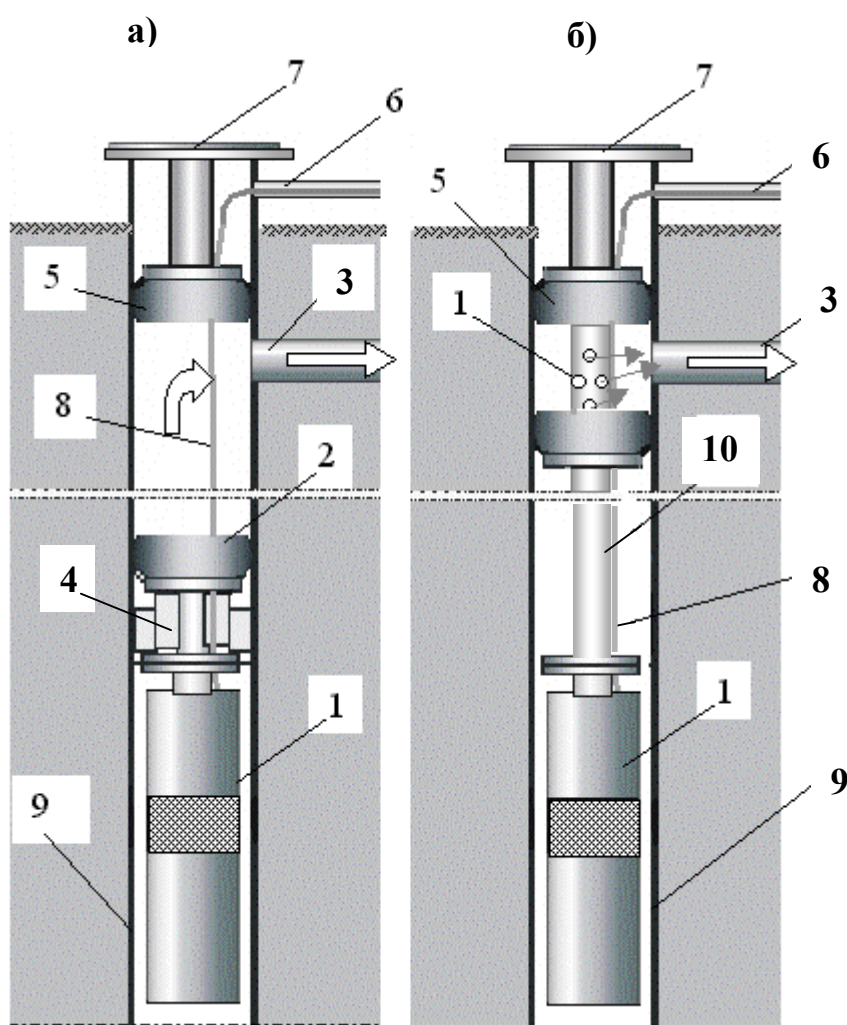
Схема установки погружных насосов в водозаборных скважинах а) с беструбной подвеской, б) с водоподъемными трубами
